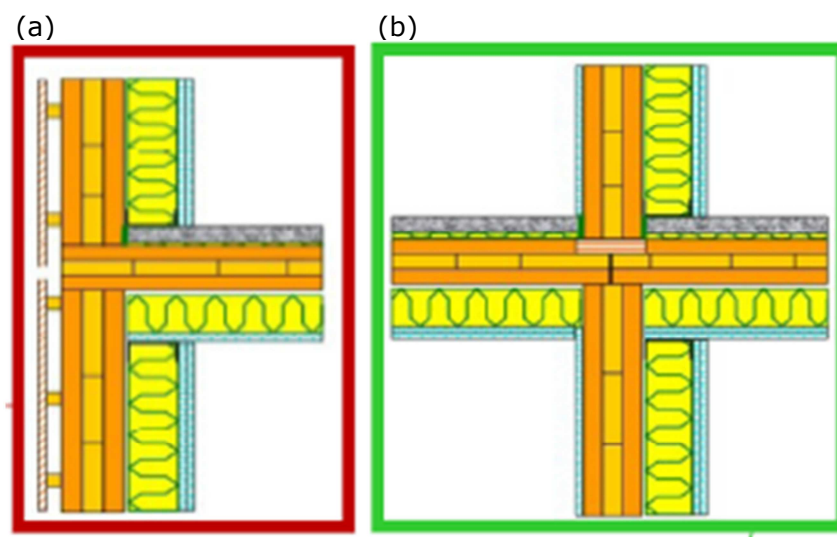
Isolement vibratoire pour une jonction en T façade – plancher.
